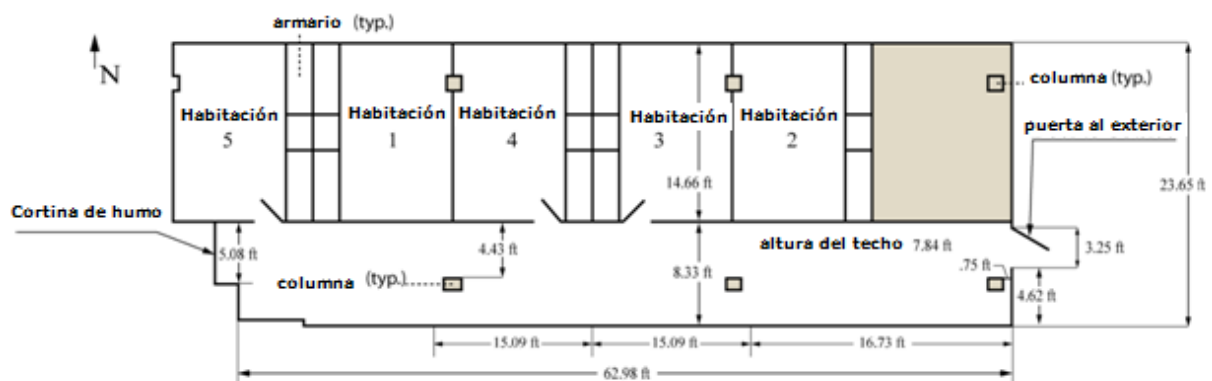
Plano de la planta baja. (Image: NIST)
